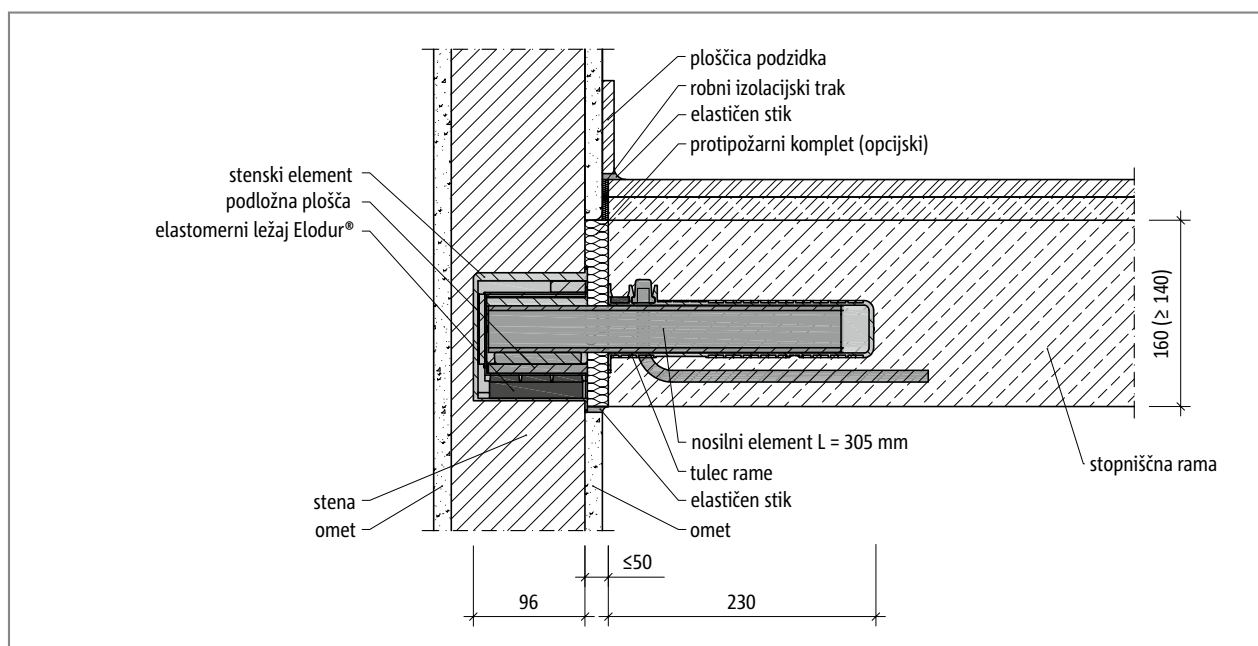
Schöck Tronsole® tip Q: vgrajevanje pri debelinah plošč  $h \geq 140$  mm ob upoštevanju debeline pokrivnega betona  $c_{nom}$
